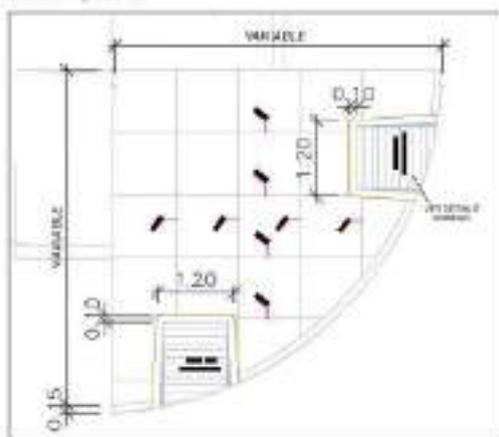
Detalles Carril giro der. Propuesta – Av. Primavera E – O
